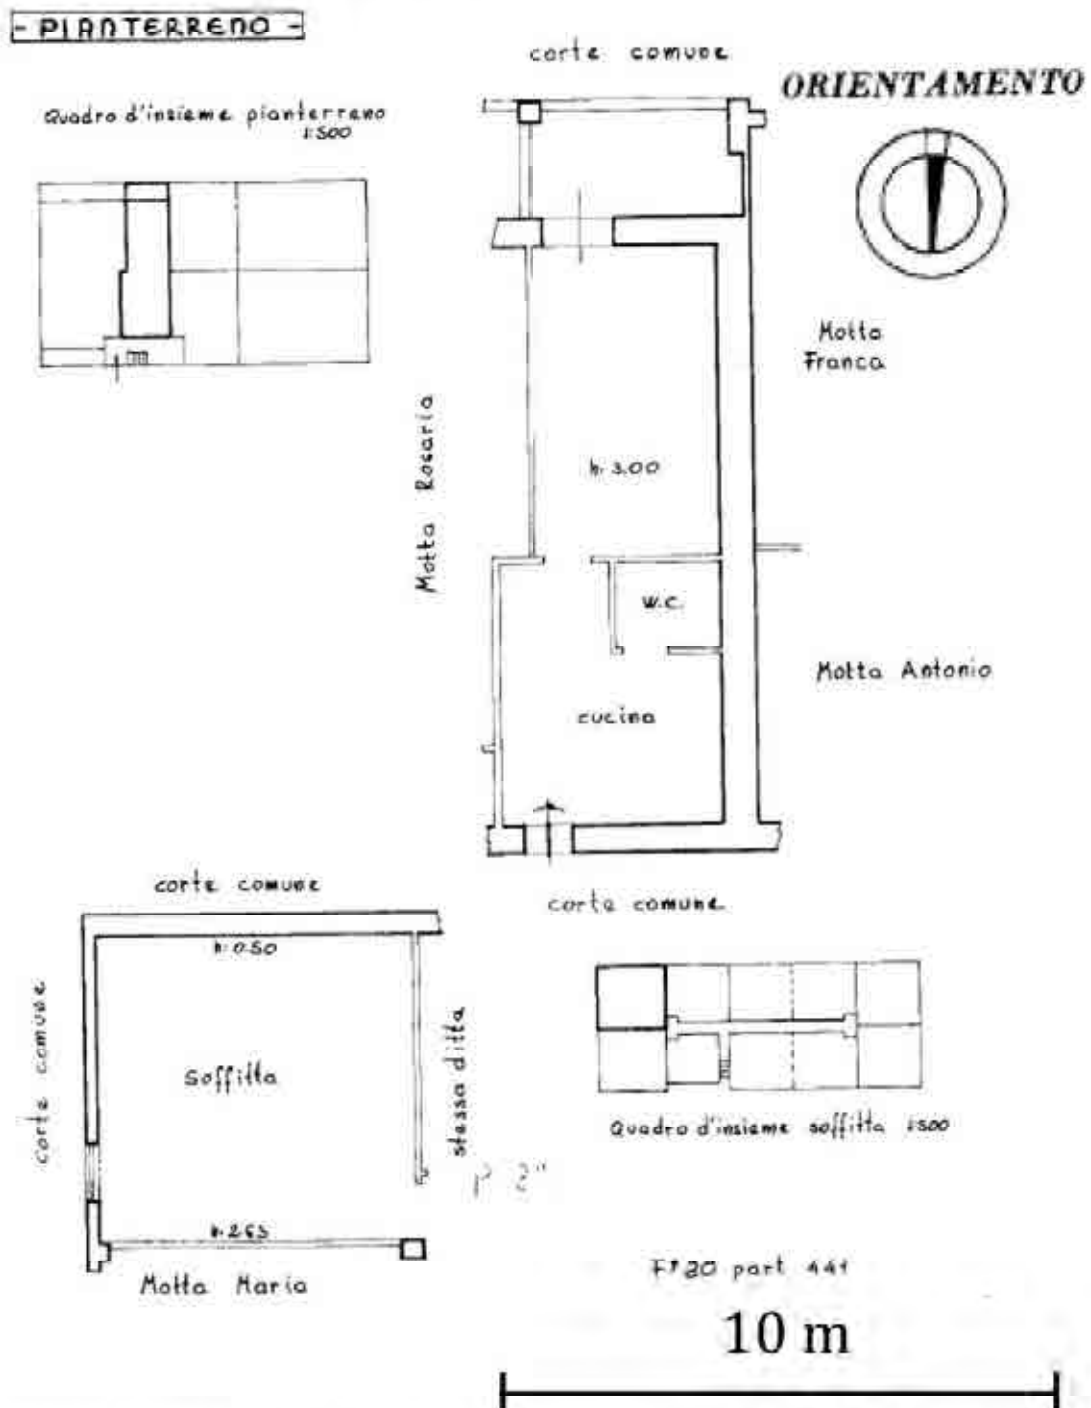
Estratto Planimetria Catastale - Appartamento NCEU Foglio ■ part. ■ sub. ■ Piano Terra e 2°
